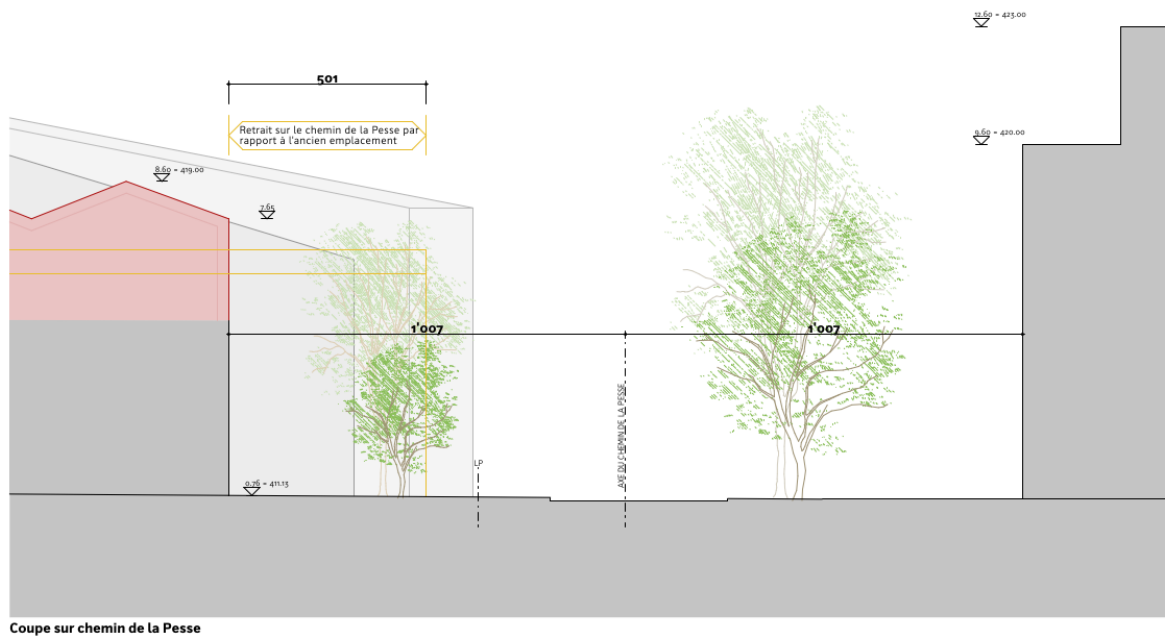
Coupe allée de façade en façade – PLQ vers PLA – chemin de la Pesse
